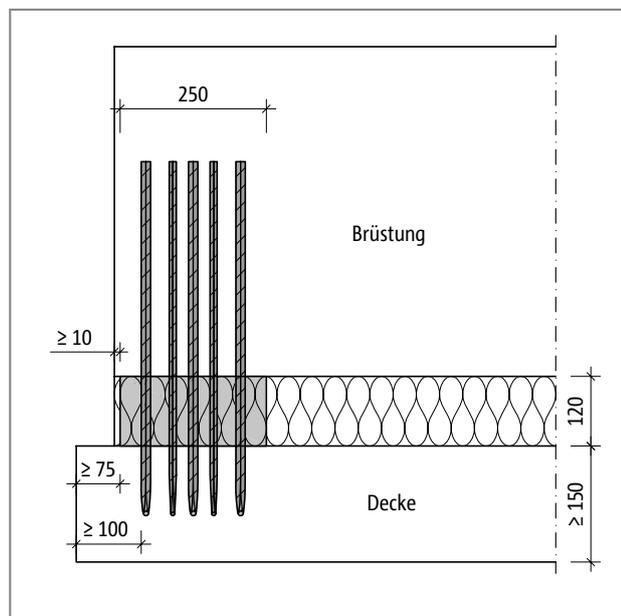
Schöck Isokorb® Typ ABXT vertikale Anordnung: Ansicht Randabstände
